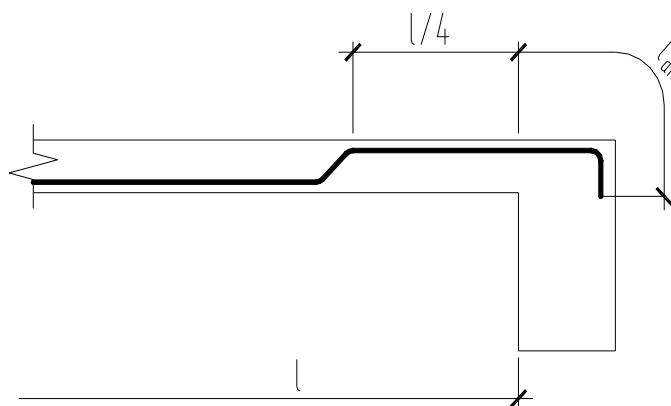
Анкерування робочих стрижнів сіток
